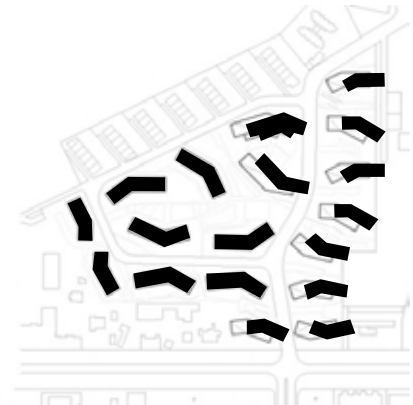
Lageplan, Quelle: Astoc Architects and Planners
